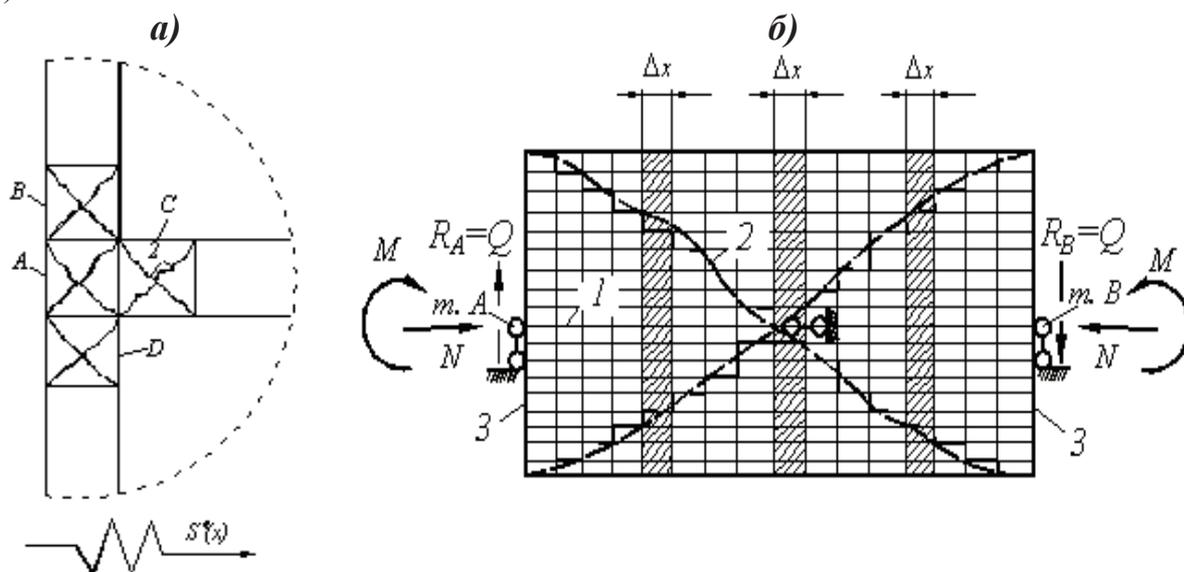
К расчету стержневых железобетонных конструкций в узловых зонах и на участках с наклонными трещинами на статические и сейсмические воздействия: а – выделение характерных зон и схем трещин; б – расчетная модель для уточнения жесткости выделенных зон; 1 – горизонтальные границы конечных элементов; 2 – трещины; 3 – абсолютно жесткие торцевые вставки
